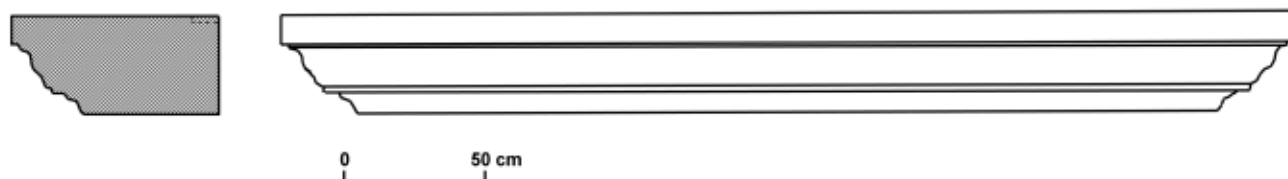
Travessa de João Galo, nºs 4-4B. Fase III. Elemento arquitectónico (cornija) de calcário.
